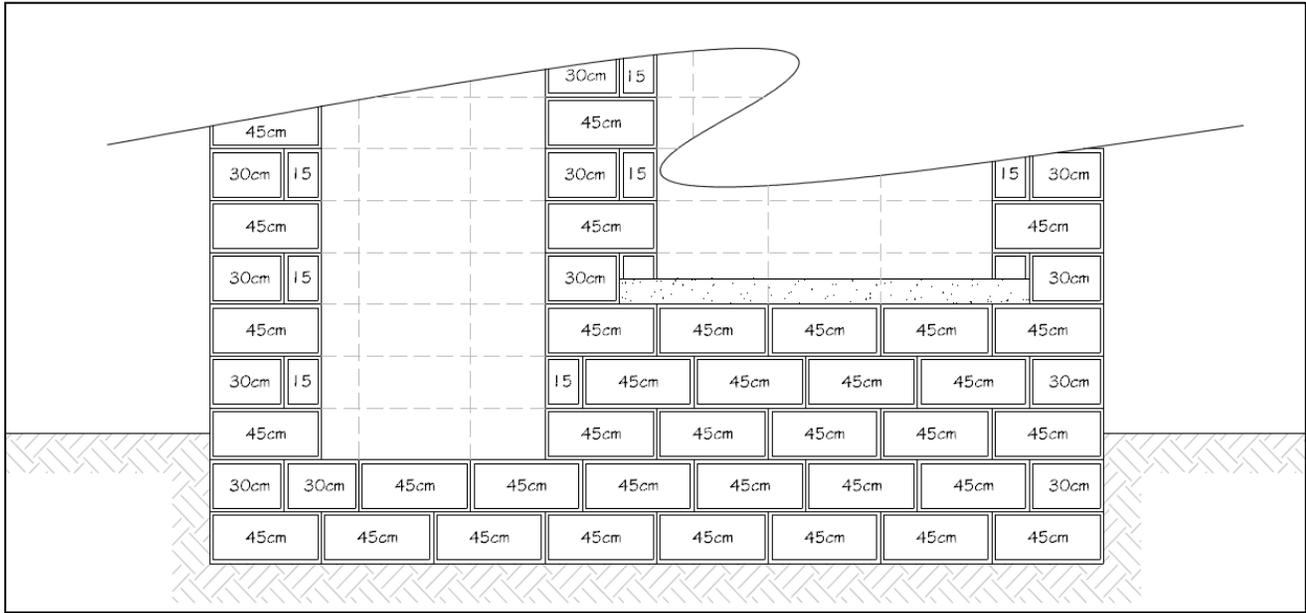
Esquema de colocación de mampostería en las distintas hiladas.
